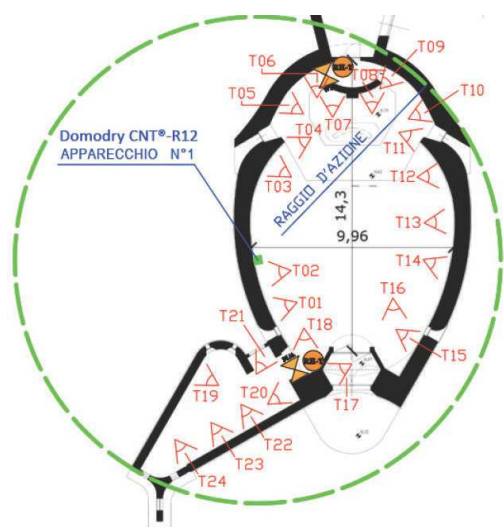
Chiesa di Santa Maria Assunta: schema planimetrico impianto CNT
